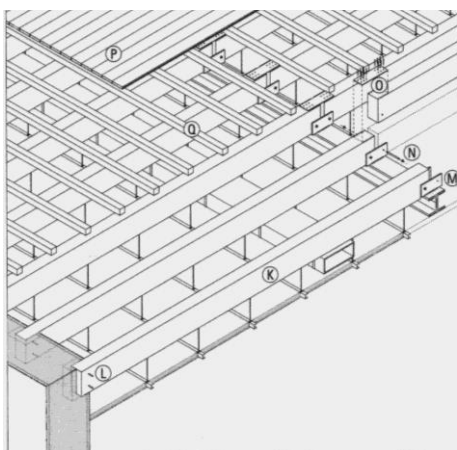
CAV-estrutura do pavimento, piso 0 ^[36]
